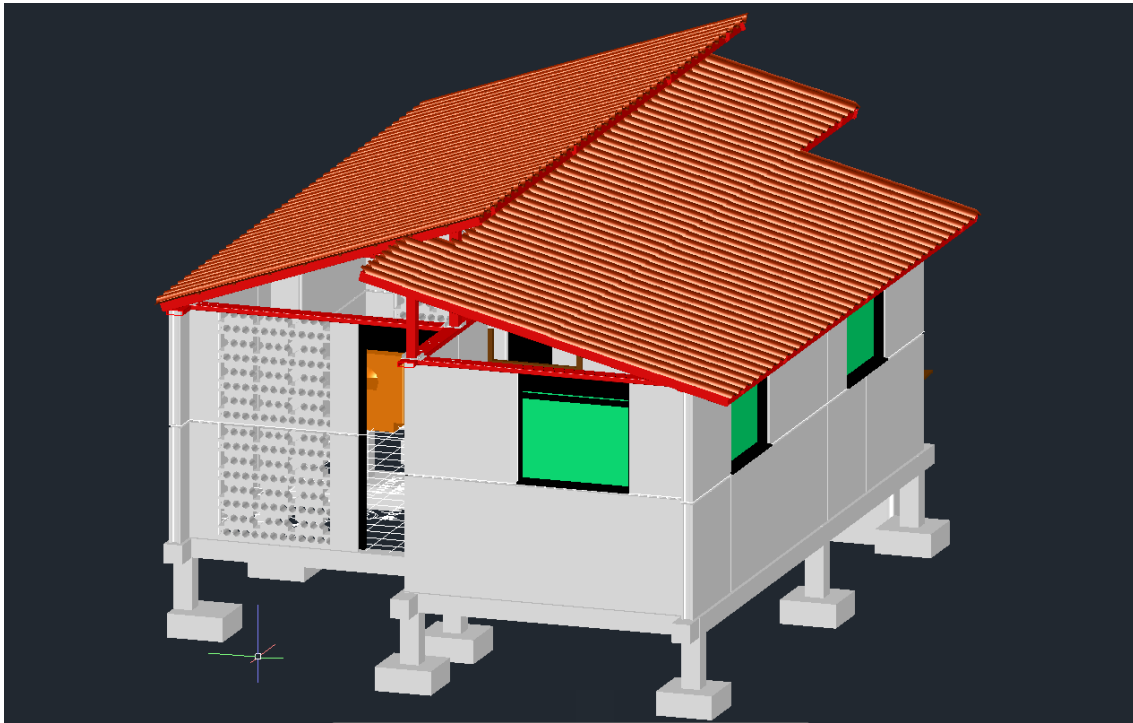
Isometrico de casa modelo construida con prefabricados OSTIF.
